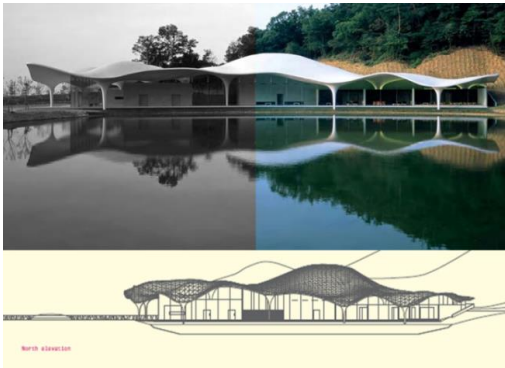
Arriba: © Shinkenchi-sha, <<Sin título>>, 2006, Vista y elevaciones del "MEISO NO MORI CREMATORIUM" diseñado por el arquitecto Toyo Ito en colaboración con el ing. Estructural Mutsuro Sasaki, este trabajo muestra el manejo de una estructura de superficie activa y su relación entre la forma y la estructura, se nota la superficie sinuosa que el concreto armado puede tomar. En la vista se puede observar la escasez de apoyos, resuelto con una cubierta alabeada que simula a una cúpula, pero en este caso todo armado como una sola pieza <http://210.10.254.97/CplusA/issue10/Meiso%20no%20Mori%20Issue%2010.pdf>. Abajo: © Shinkenchi-sha, <<Sin título>>, 2006, Ilustración del alzado norte, muestra las líneas que forman la superficie, las cuales serán necesarias para determinar la ubicación de la cimbra: Una sucesión de tiras de madera que darán forma al concreto. <http://210.10.254.97/CplusA/issue10/Meiso%20no%20Mori%20Issue%2010.pdf>
